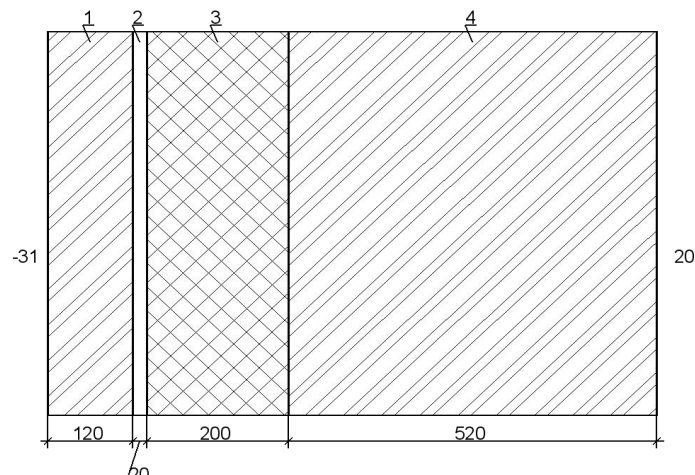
Конструкция наружной стены с тепловой изоляцией
